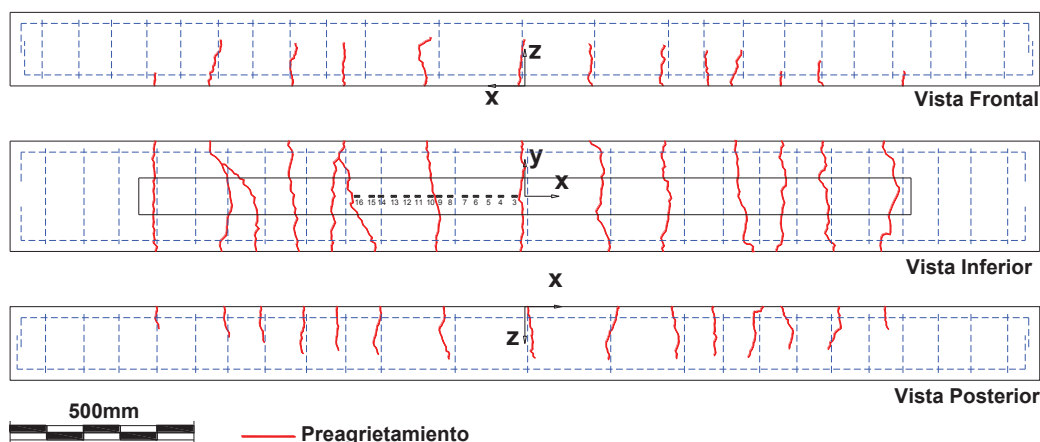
Esquema del patrón de agrietamiento de viga 1A.
